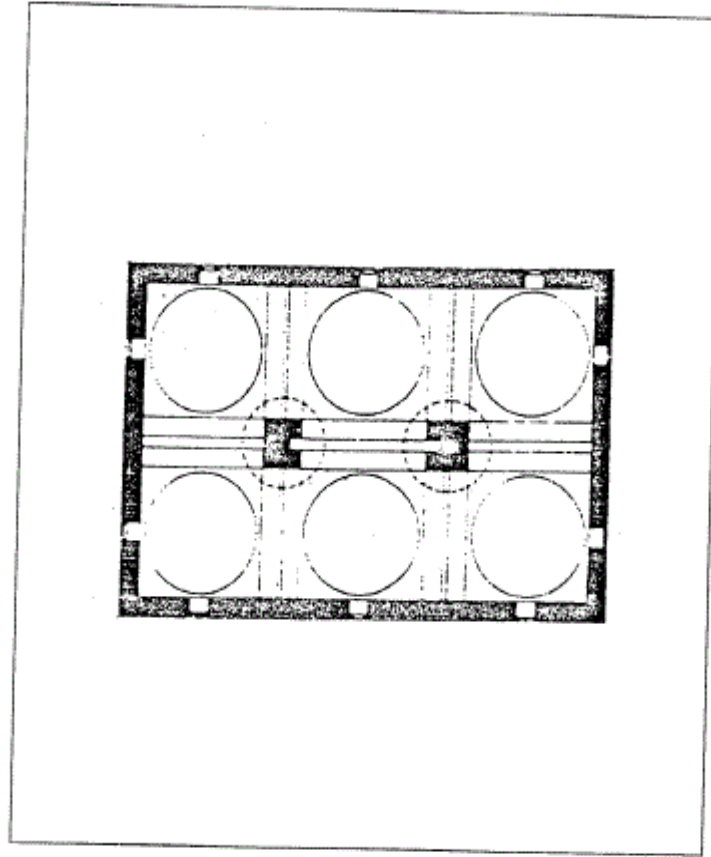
مسقط أفقي لخلطة بادستان باستانبول (عن: Cezar).
